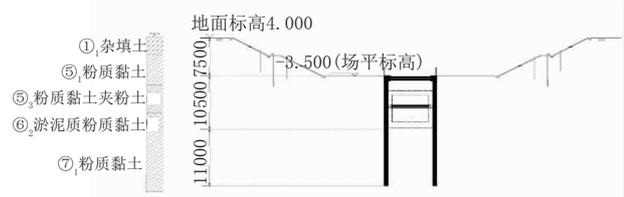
出入线段基坑 E 区围护剖面图(单位:mm)
